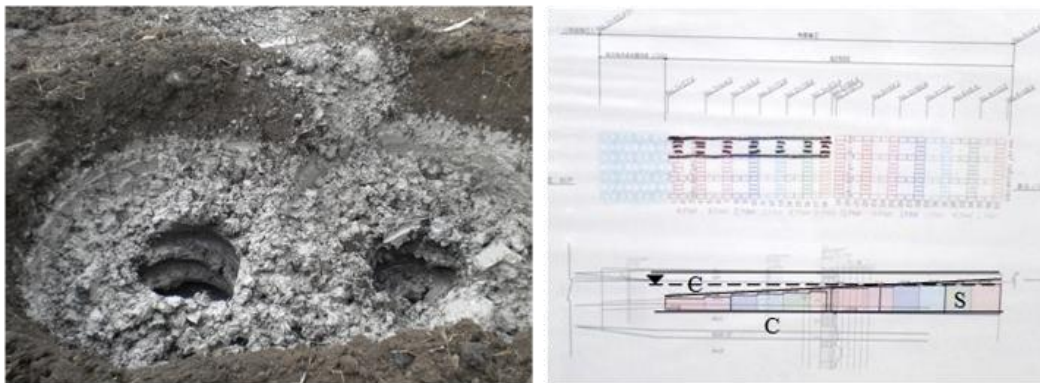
Unità di trattamento, schema planimetrico e sezione del trattamento.
